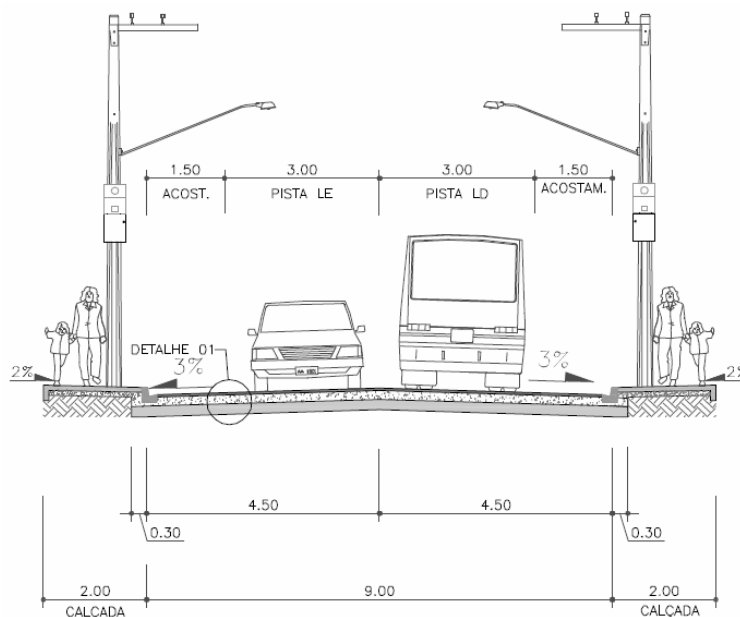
Perfil transversal do acesso 1 ao conjunto Santa Lúcia e Eixo 04 acesso ao povoado Santo Inácio
